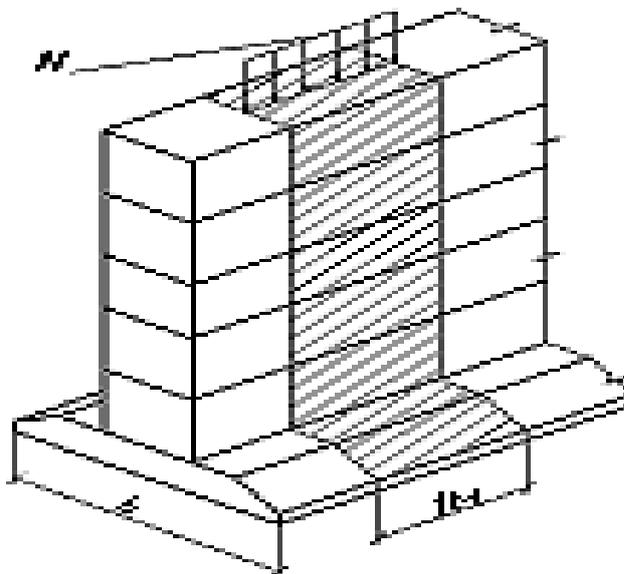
Схема сбора нагрузок на 1м длины фундамента
